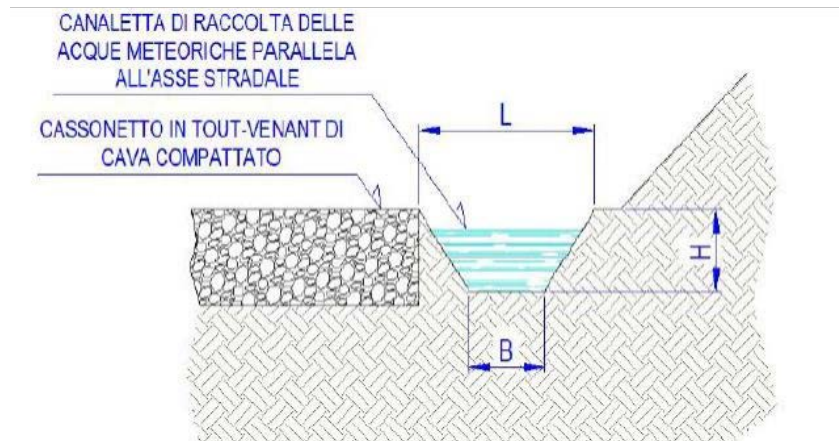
canaletta laterale di scolo delle acque- sezione tipologica
